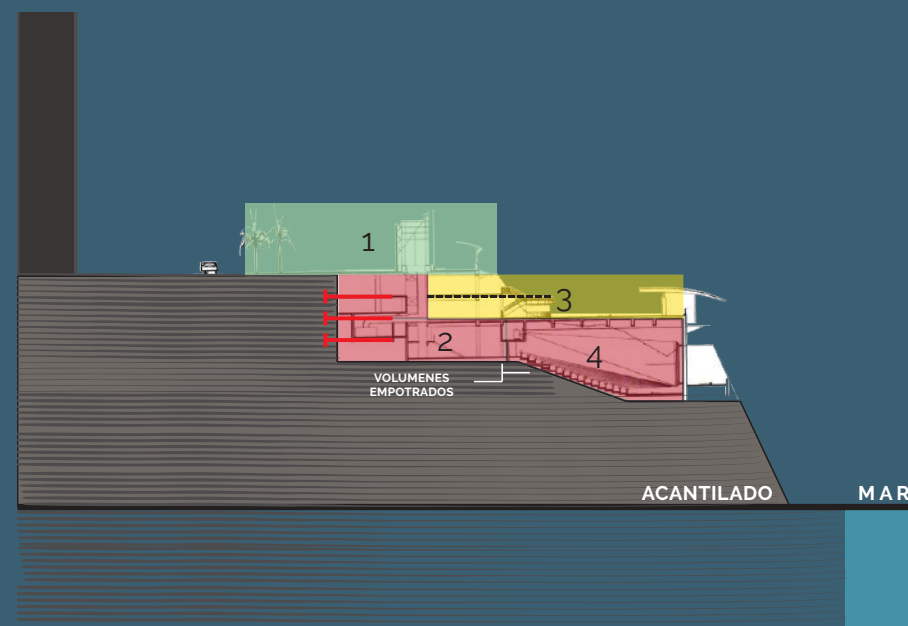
Análisis estructural: volúmenes 2 y 4 empotrados en el acantilado.
